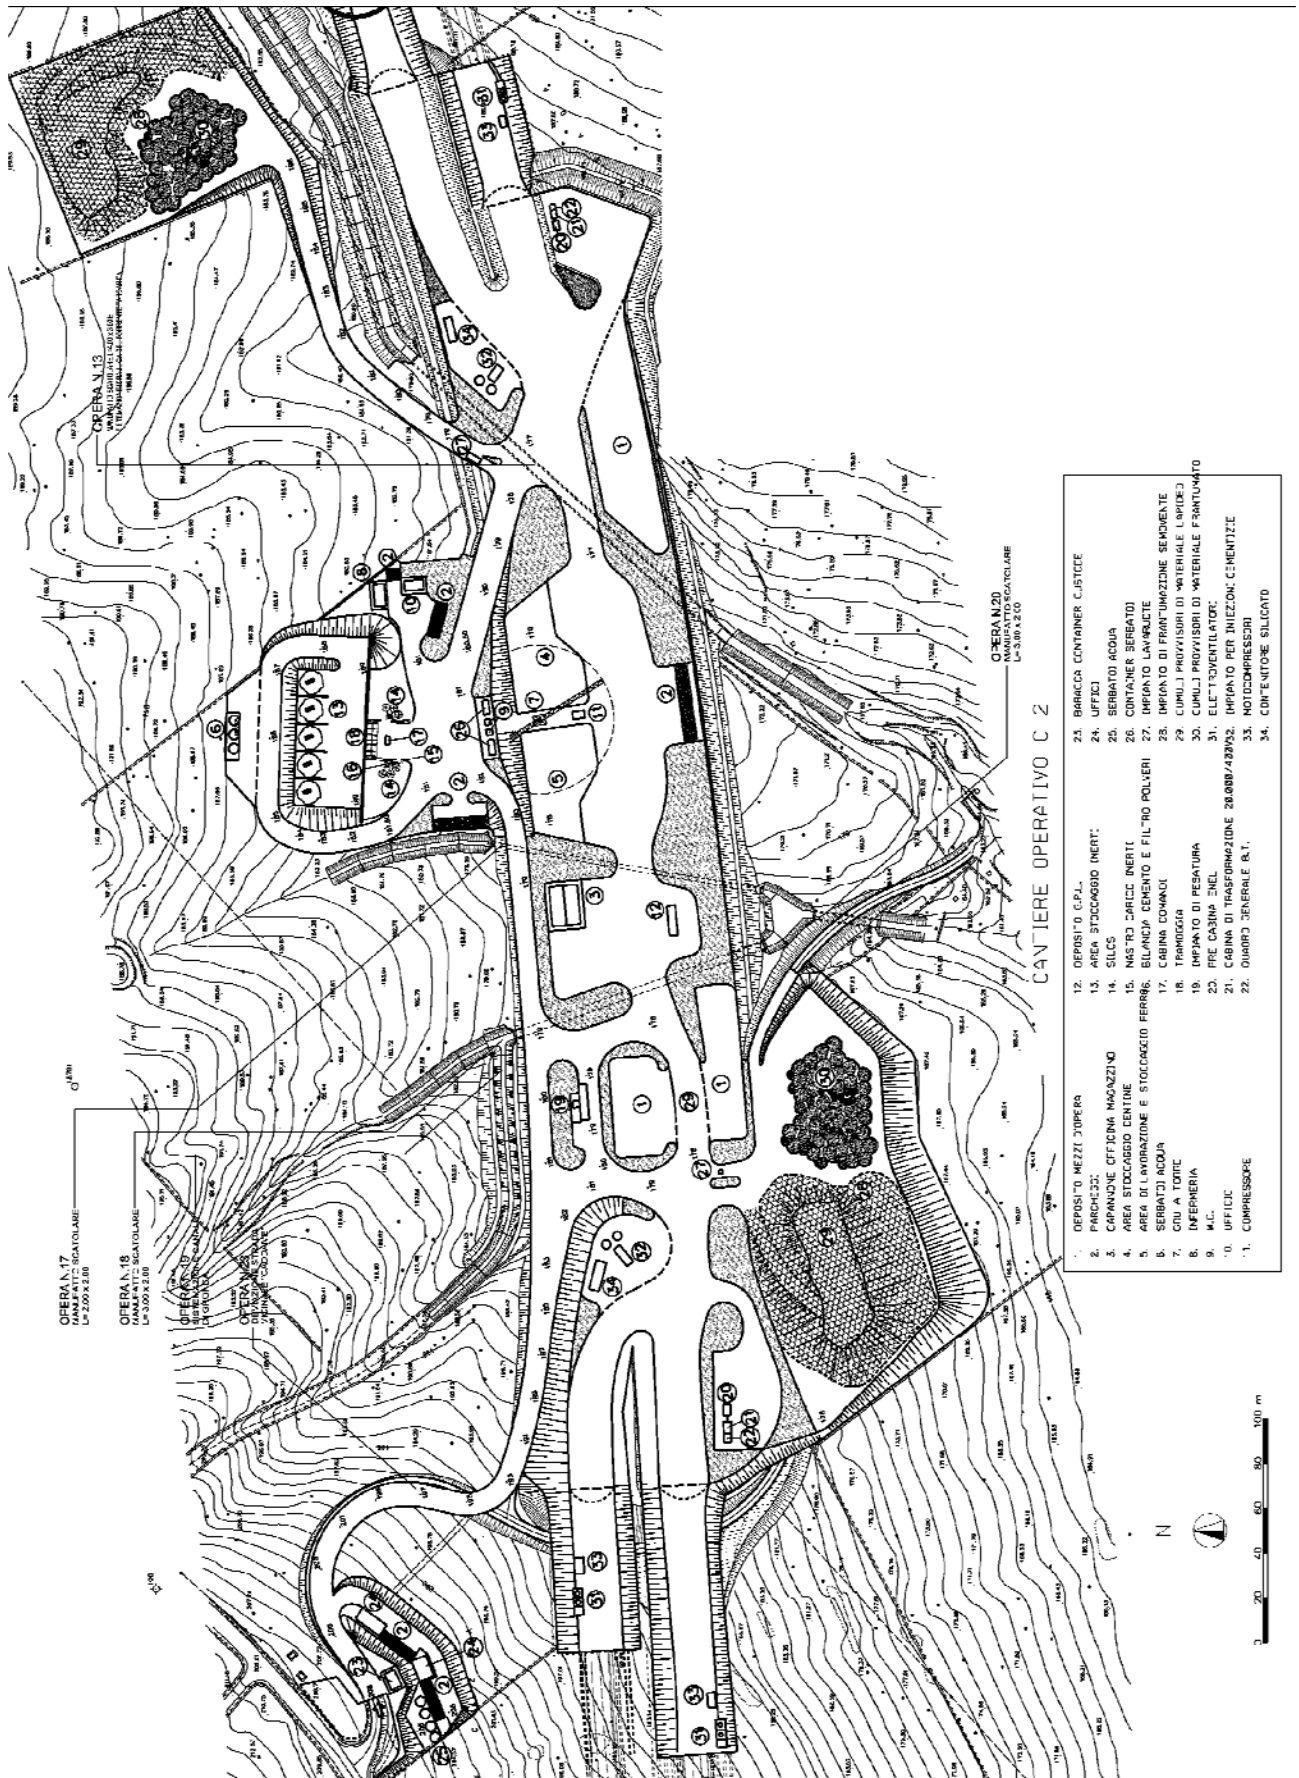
Cantiere C.2 – Planimetria schematica
